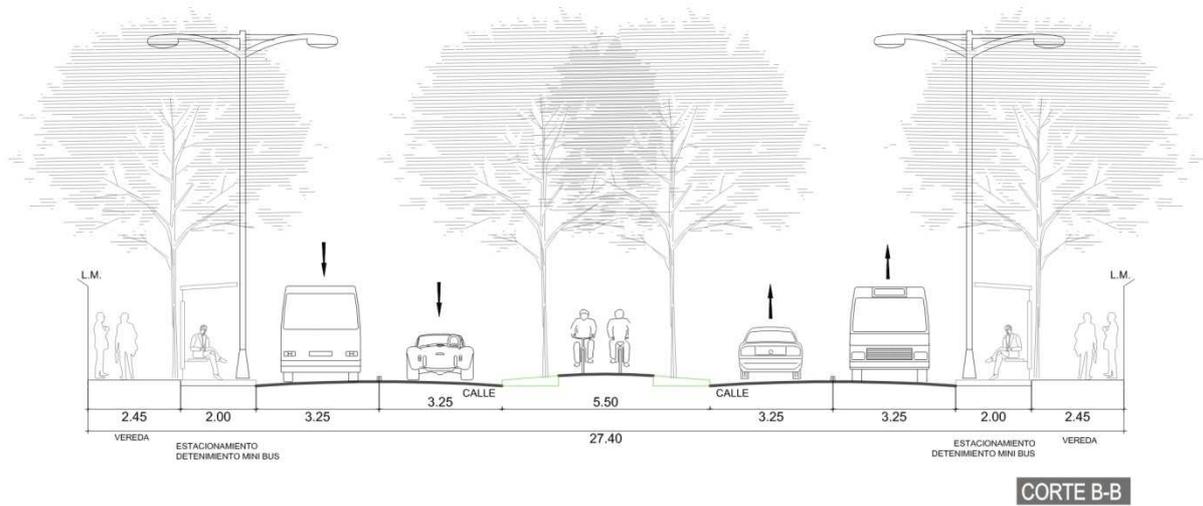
Modelo Espacial: Plano de ubicación y corte B-B ilustrando la propuesta de desarrollo urbano para el Corredor N° 1.
